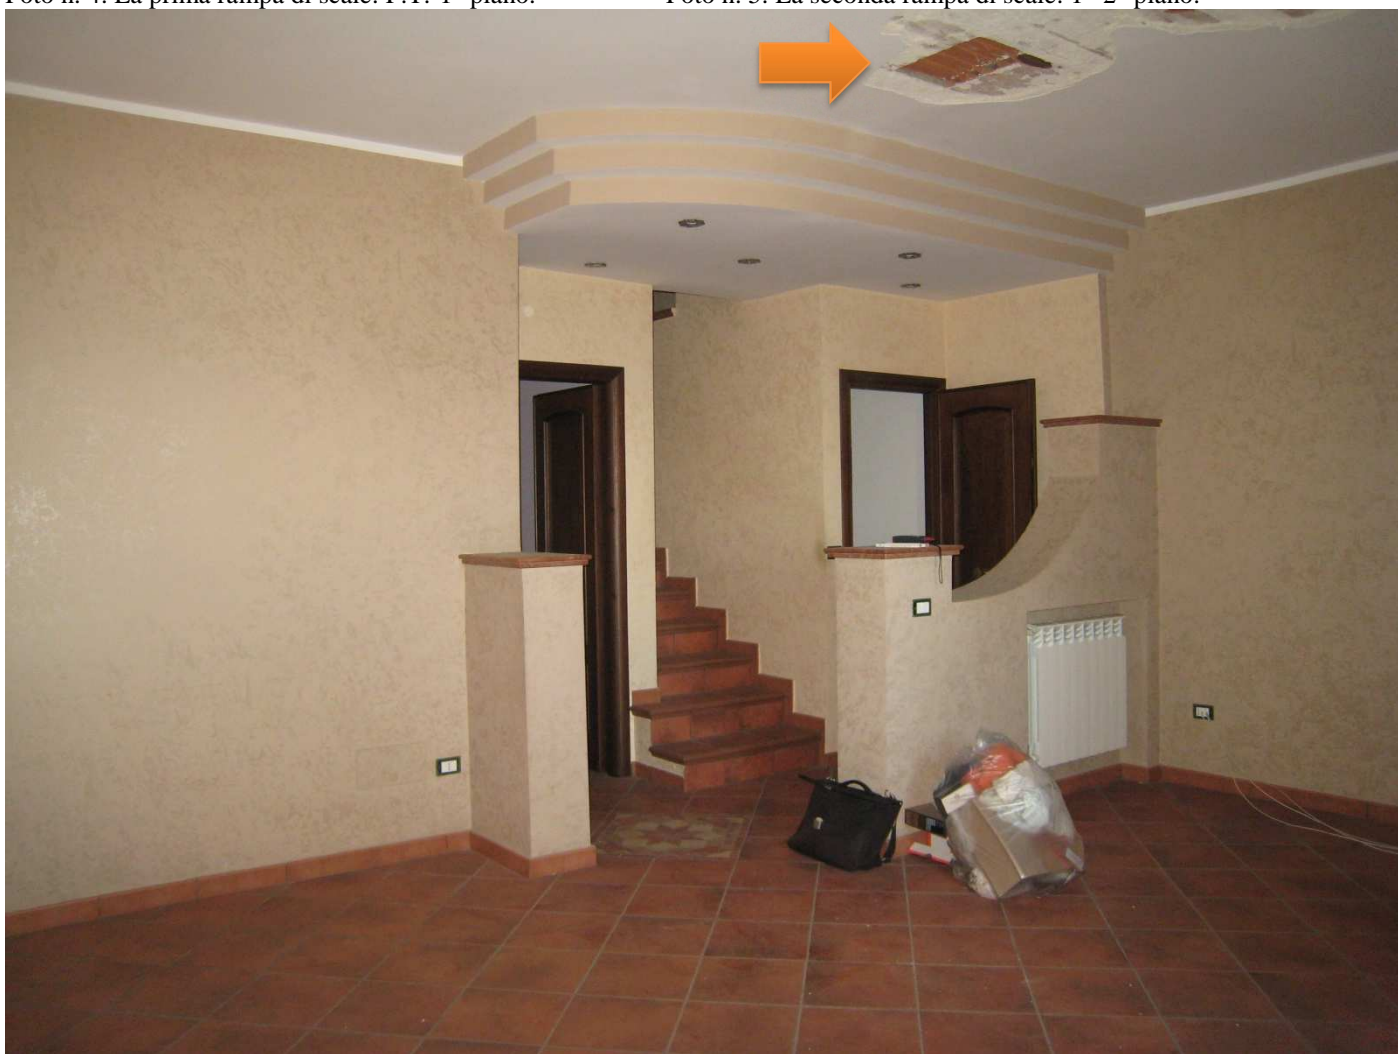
Il soggiorno di primo piano. Si notano, sul tetto, i distacchi di intonaco.
